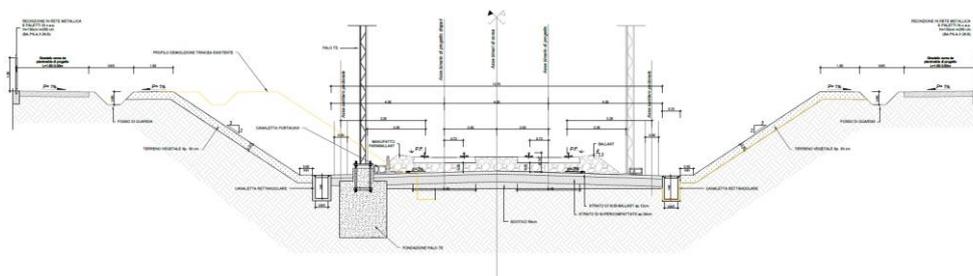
Sezione tipo in trincea con raddoppio a 4.00m
